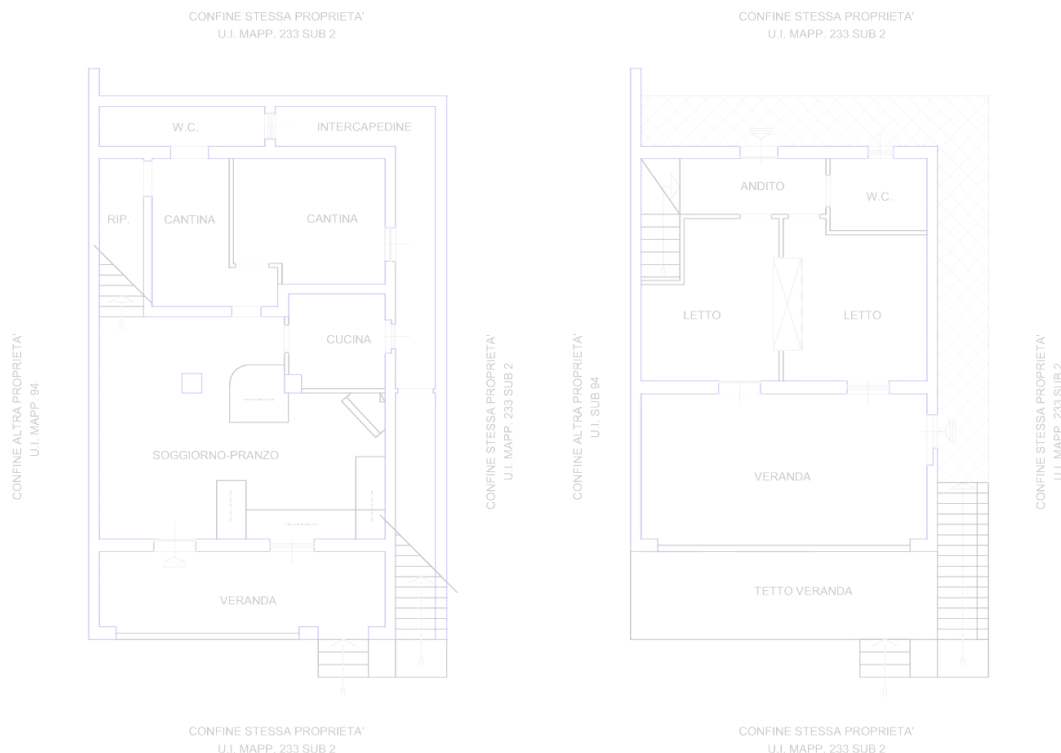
Pianta appartamento dopo rilievo primo accesso
